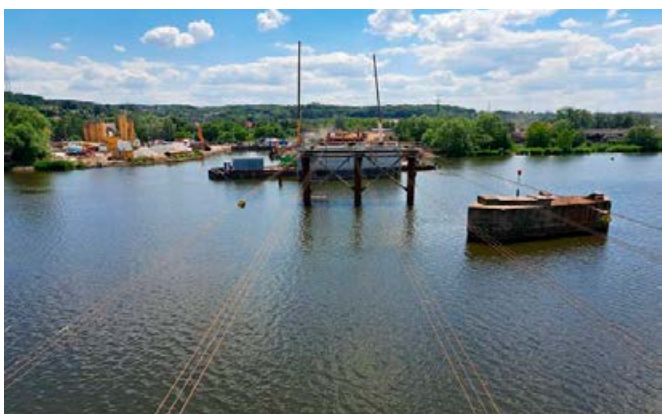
Przygotowanie nasypu – platformy do wykonania montażu konstrukcji
